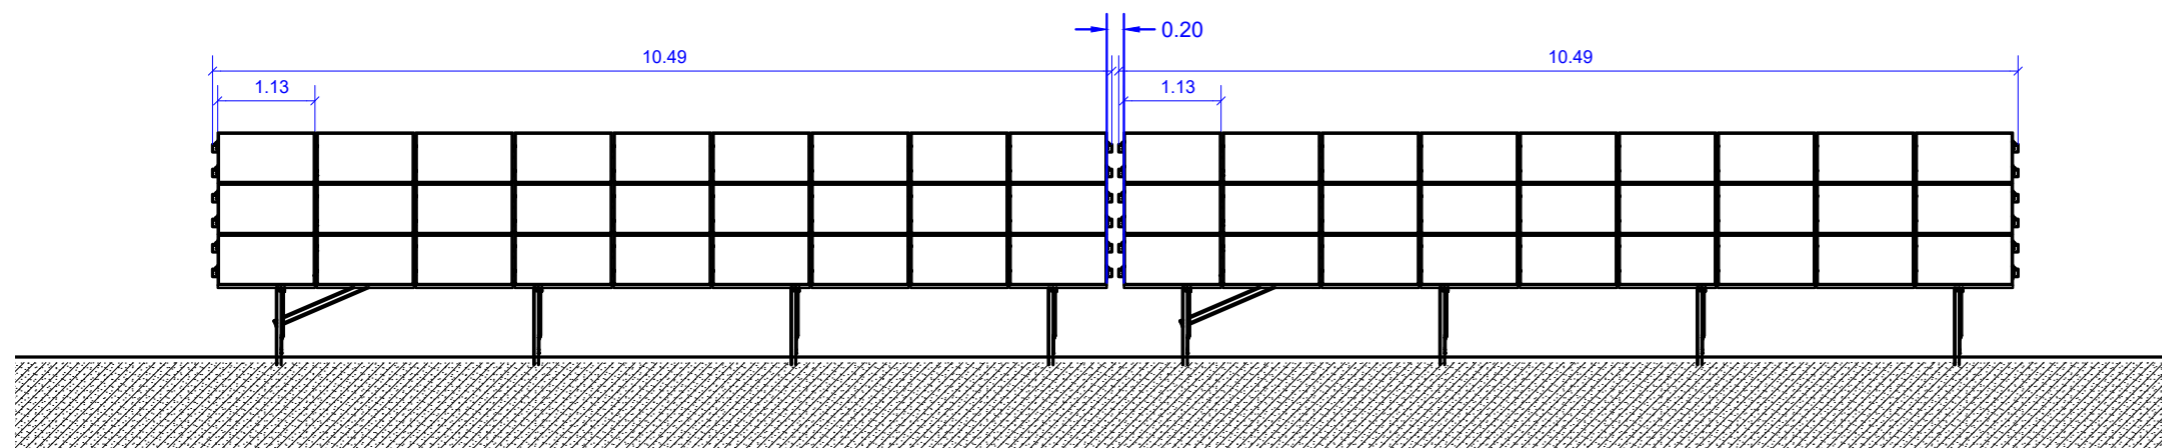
DETAIL - COUPES TRANSVERSALE DES STRUCTURES PHOTOVOLTAIQUES échelle 1/100e
